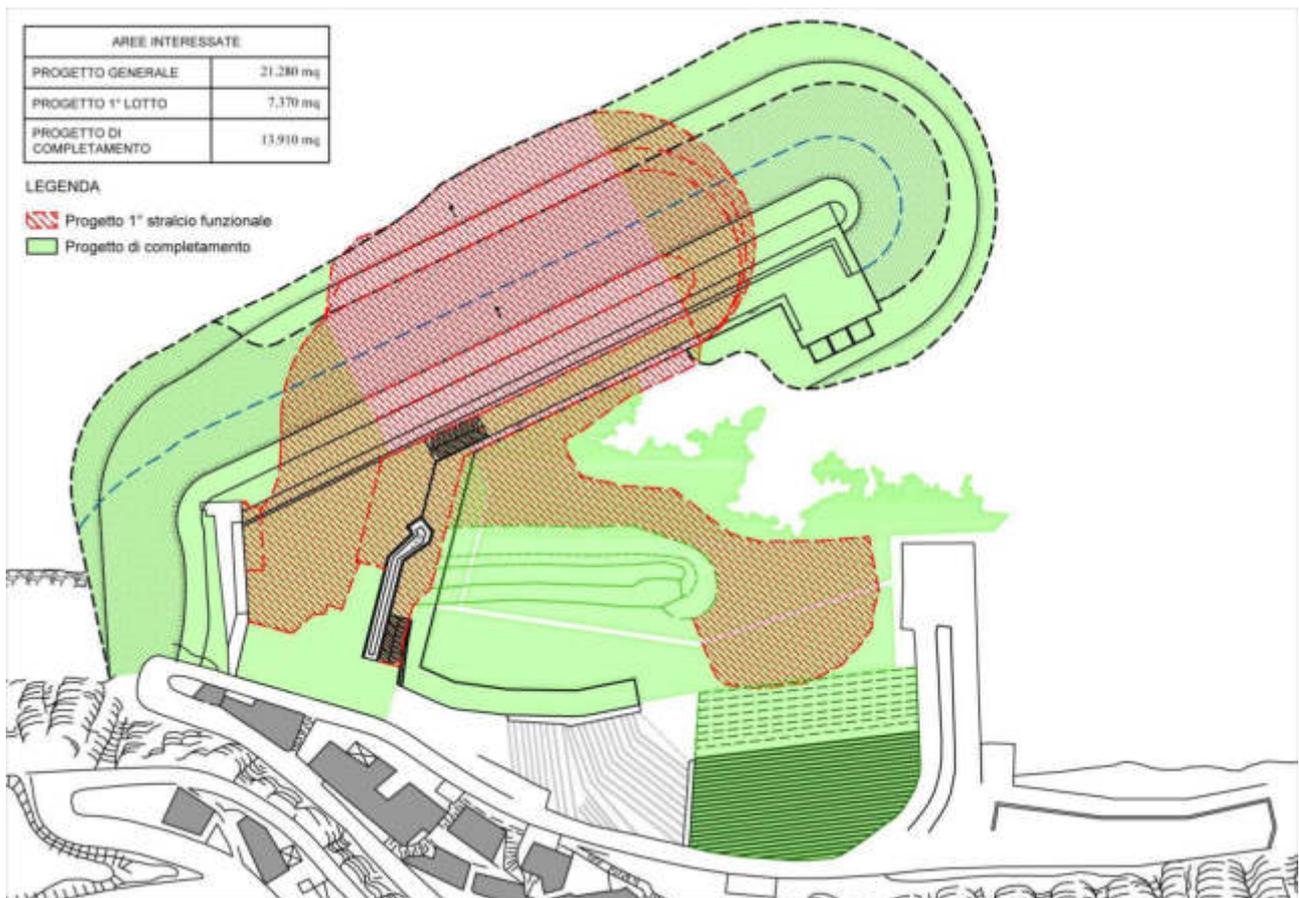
Planimetria con indicazione delle dimensioni del progetto
